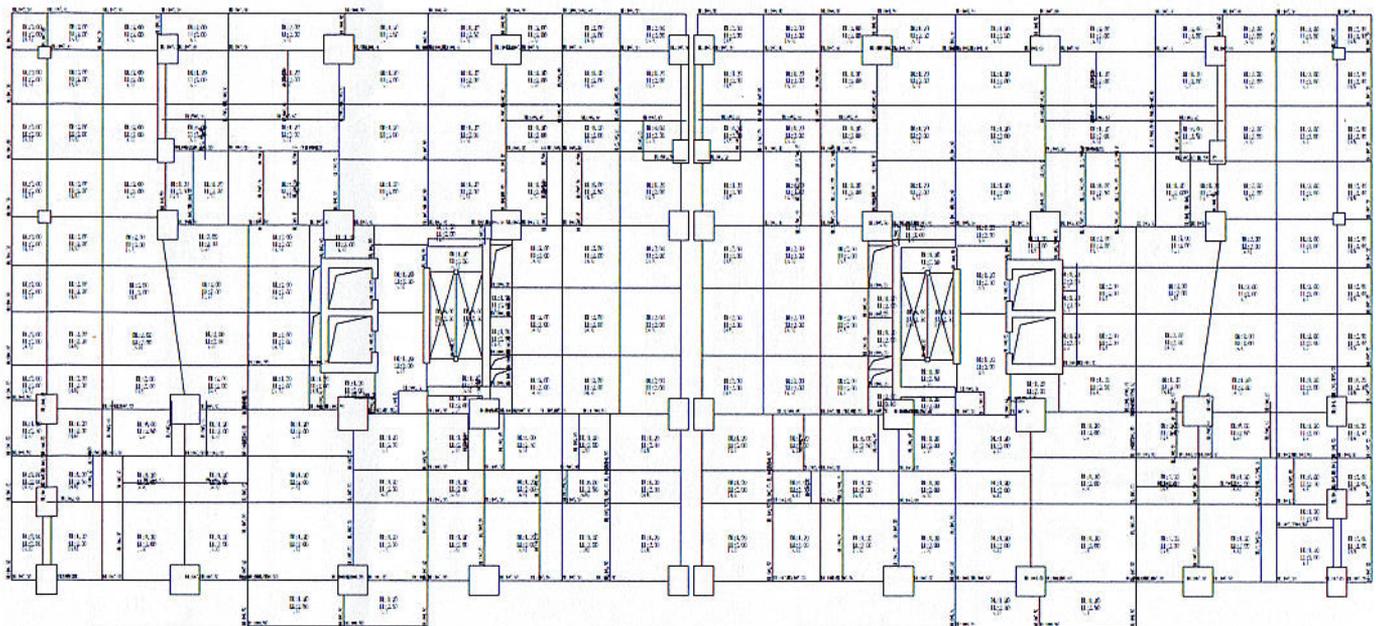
楼层节点输入荷载的荷载平面图 (单位: kN/m)
